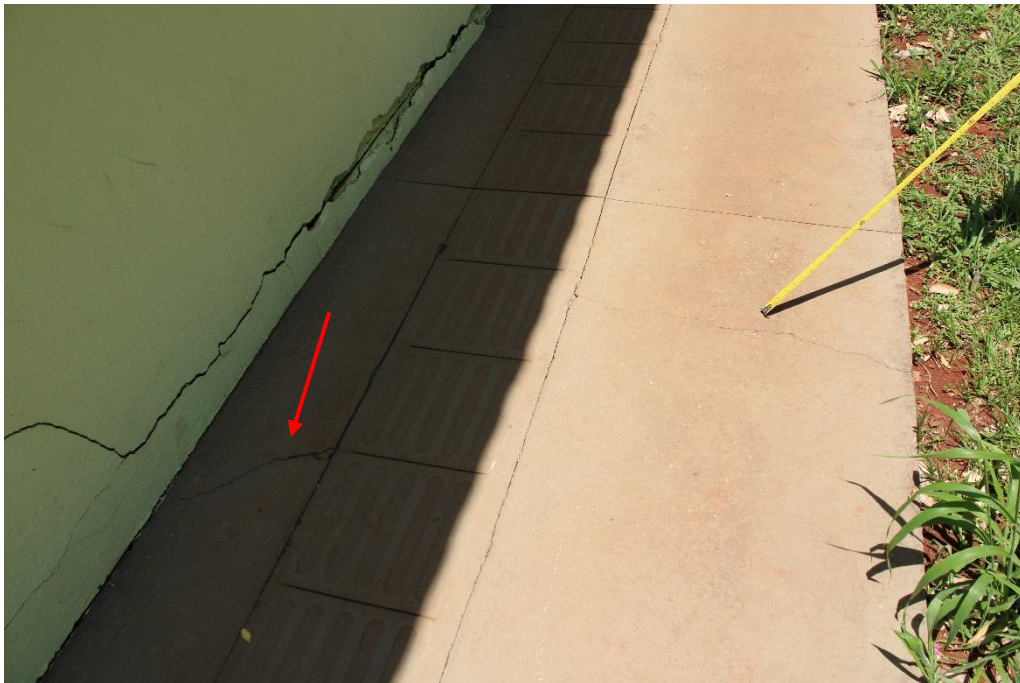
Vista parcial da Fachada Frontal, destacando fissuras no calçamento externo em concreto desempenado.
